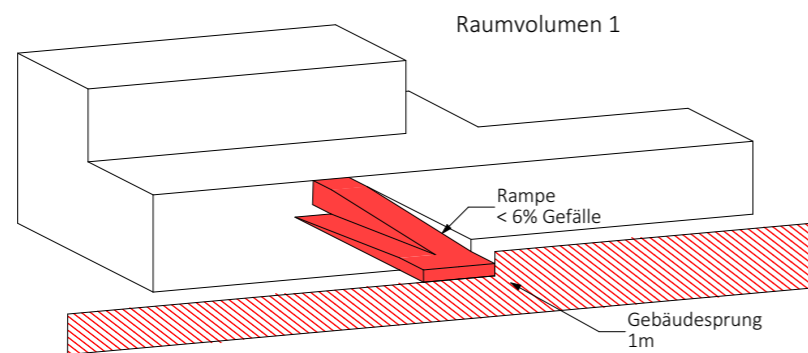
schematische Darstellung Raumvolumen 1/Verbindung Rampe
